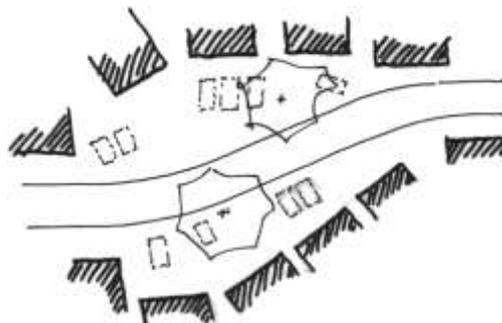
Lageplan multifunktionaler Seitenraum (Schema)
